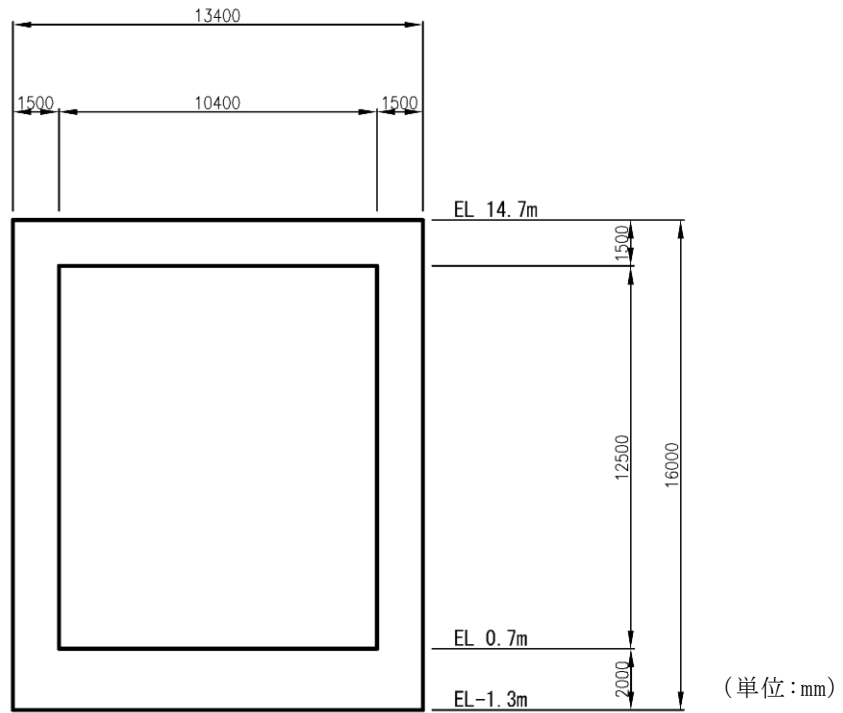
(2) 低圧原子炉代替注水ポンプ格納槽 断面図 (B-B 断面)
